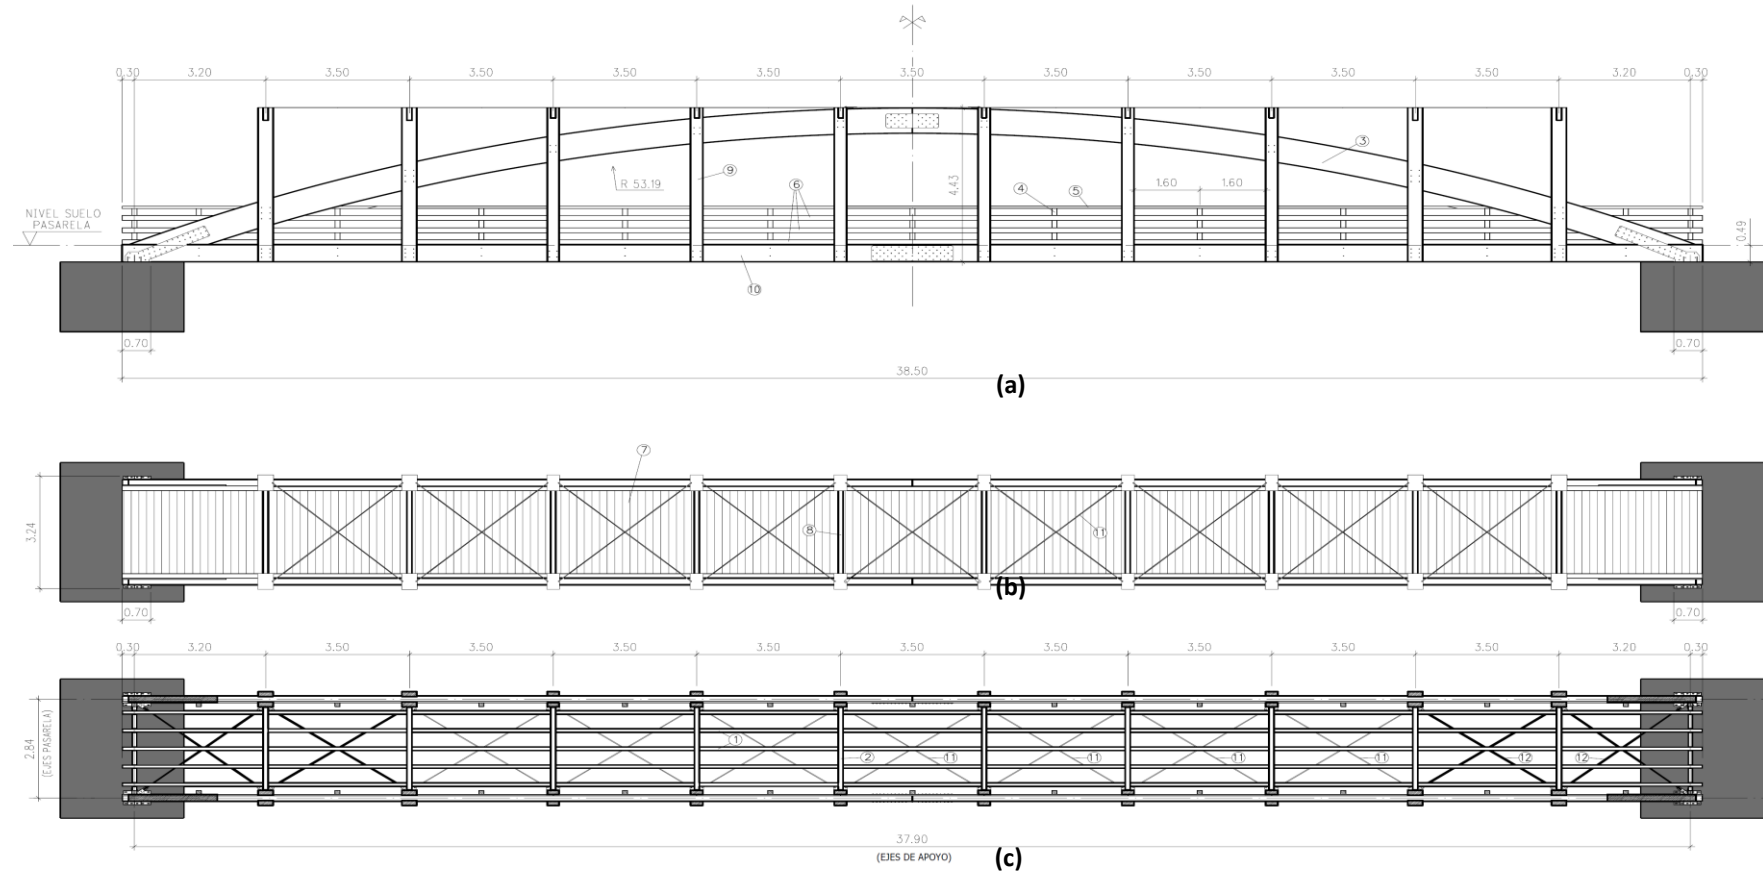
Detalle constructivo de pasarela ubicada en las Fraguas. (a) Alzado. (b) Planta superior. (c) Planta inferior. Fuente: Yofra.
